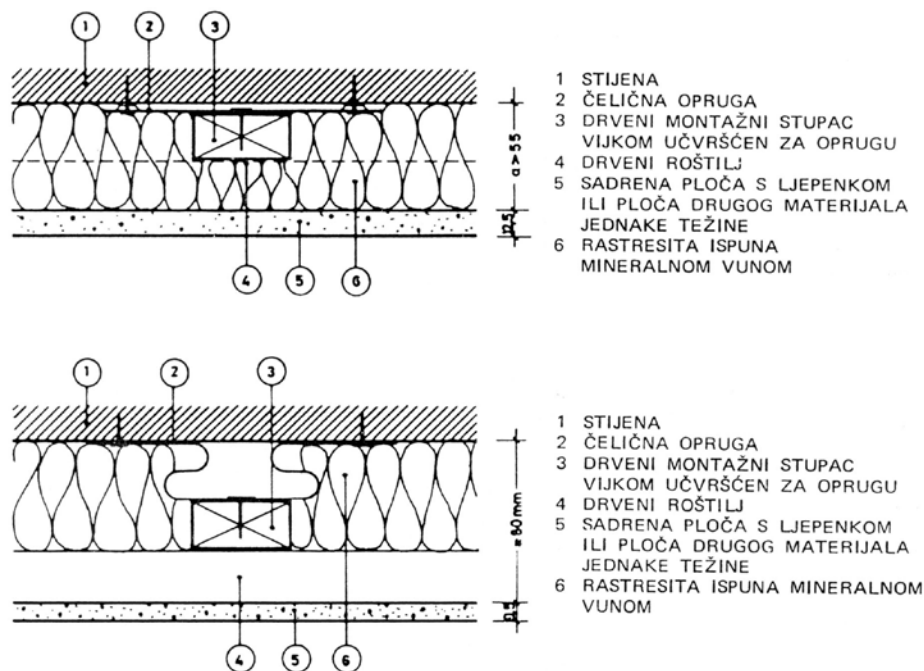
Primjer izvedbe lagane predstijenke s drvenom potkomstrukcijom
